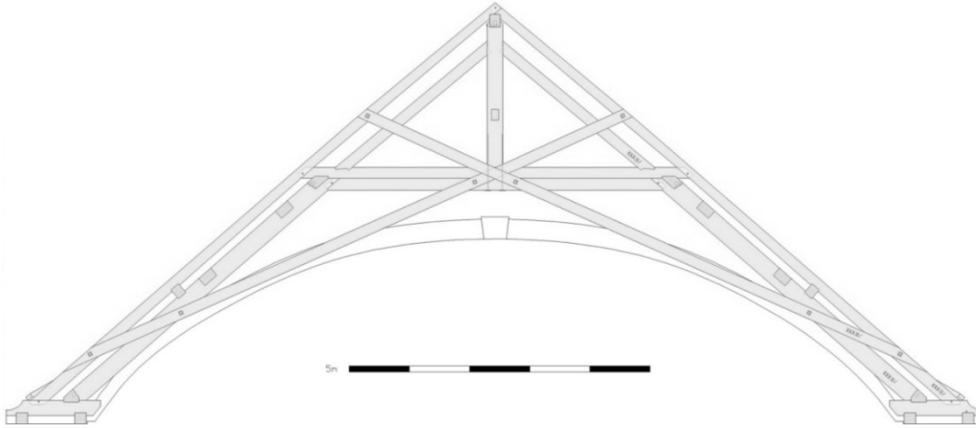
Querschnitt des Dachwerks in der Ludwigkirche in München (1835-1843) mit Kreuzstreben (2011)
